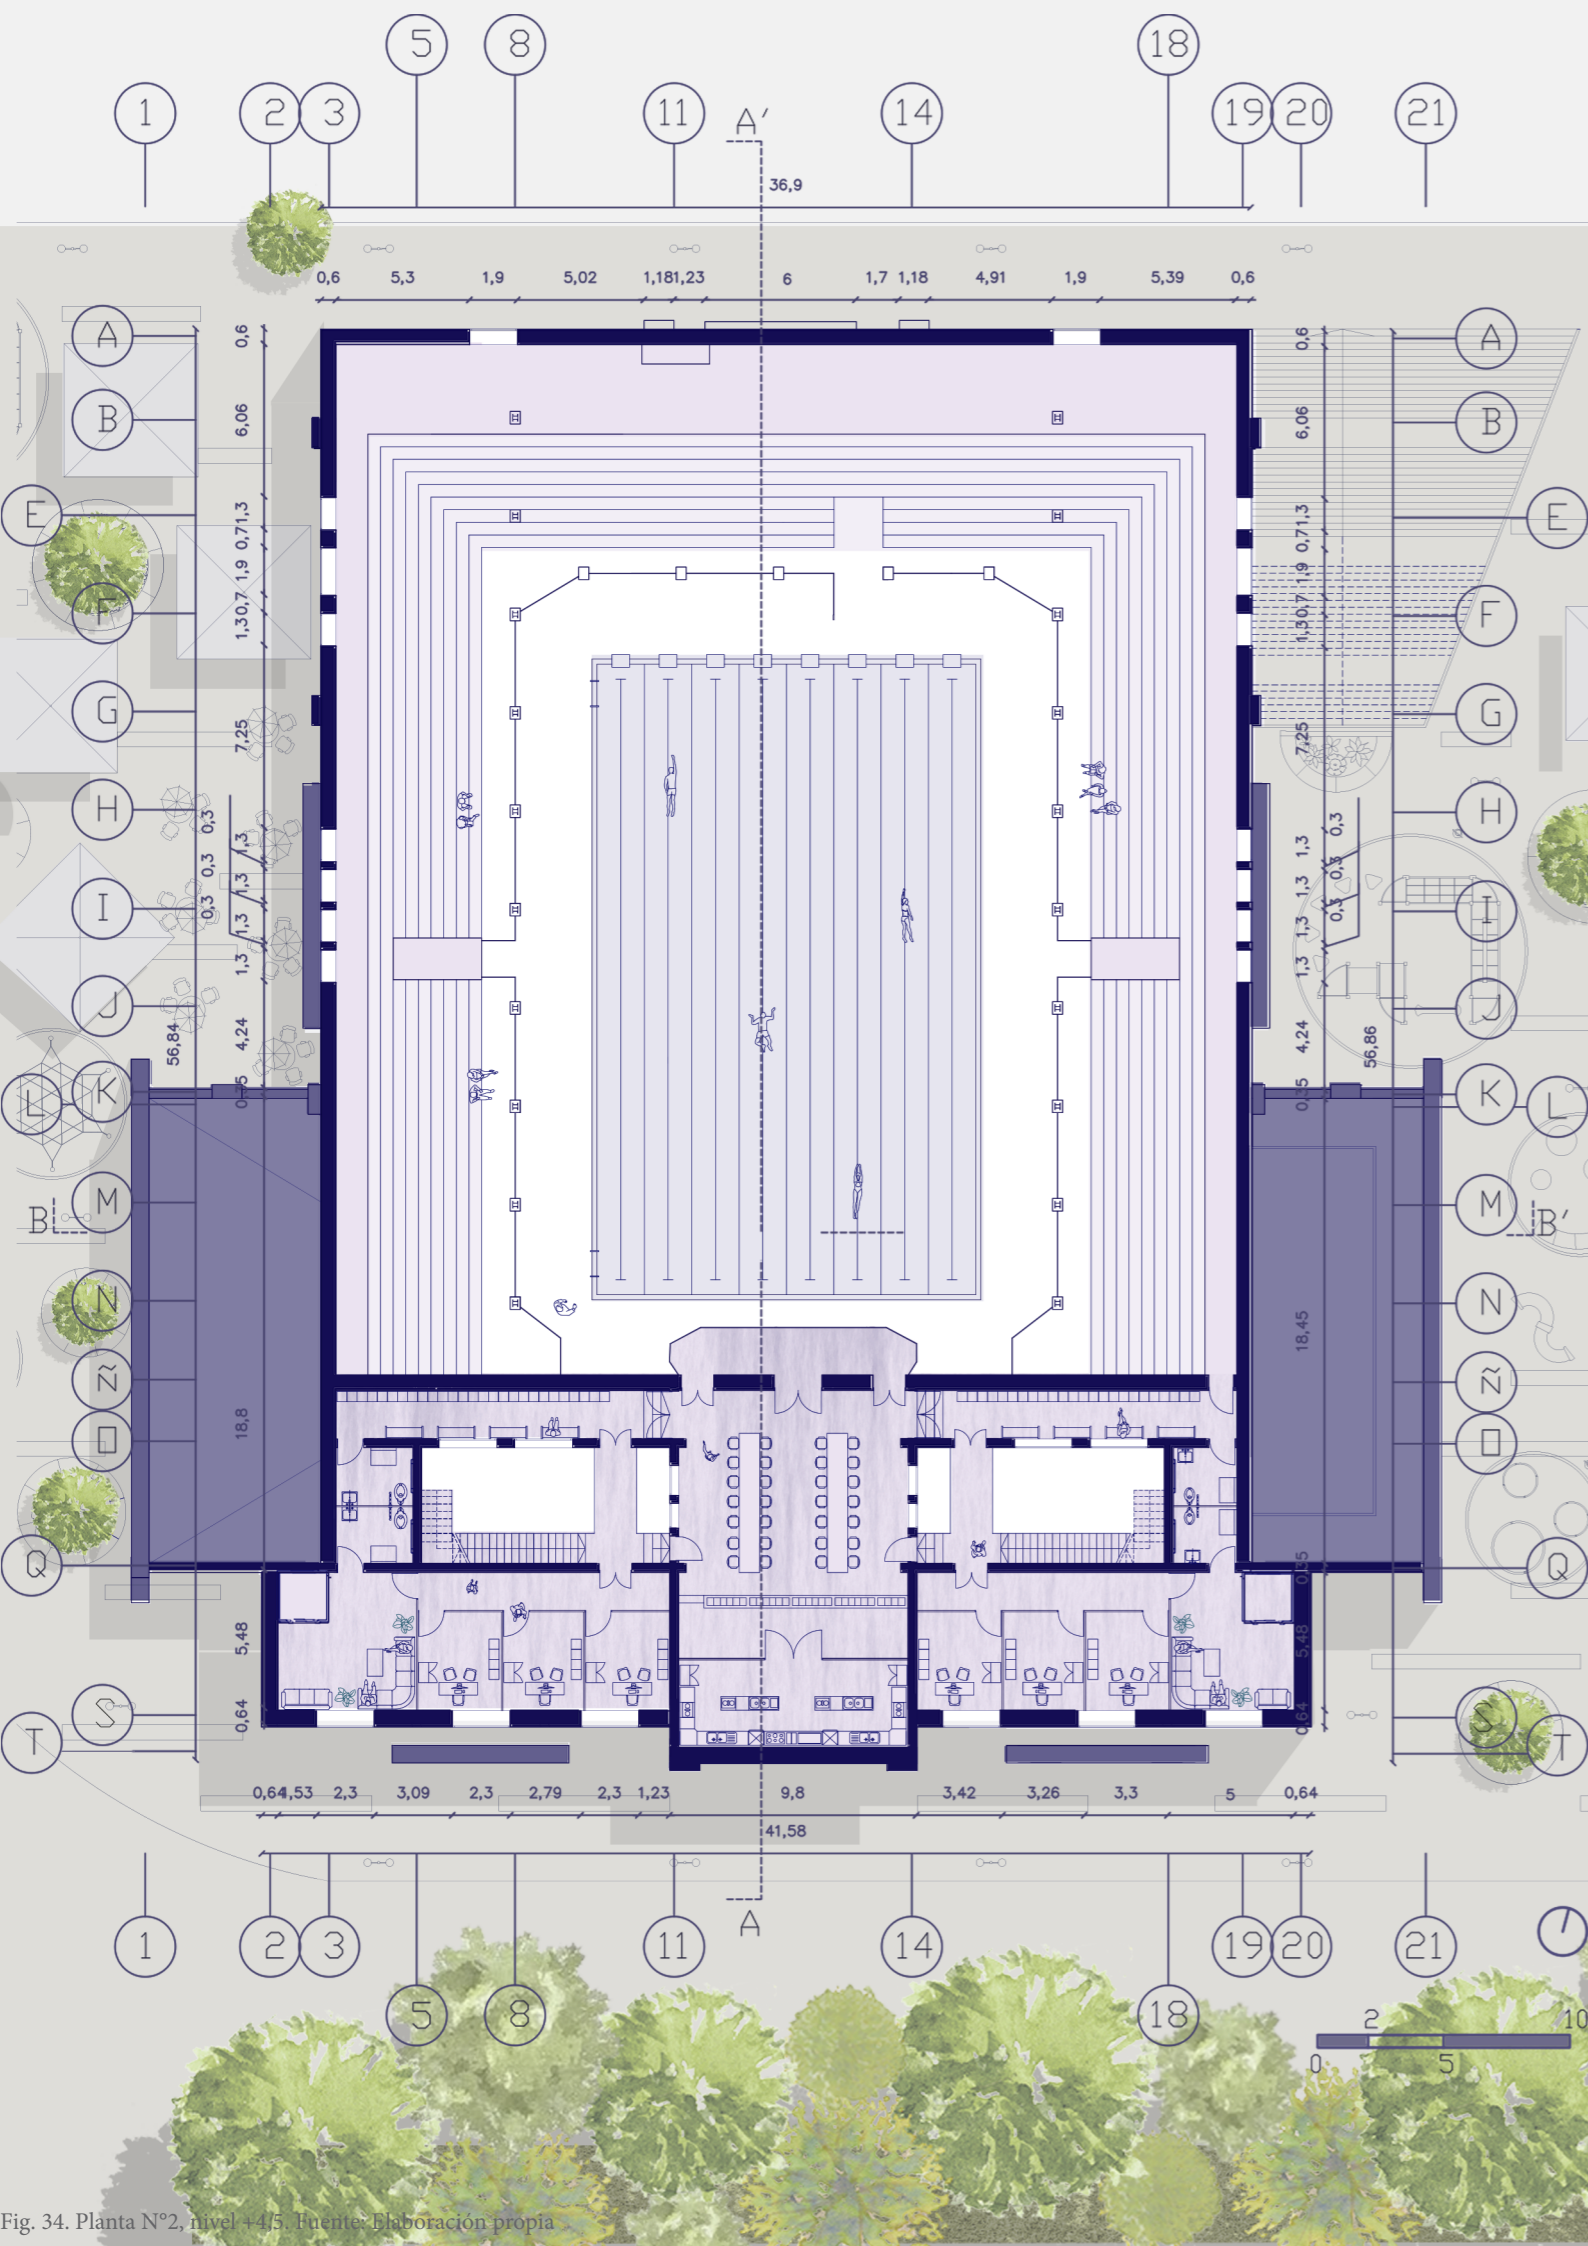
Planta N°2, nivel +4.5. Fuente: Elaboración propia
